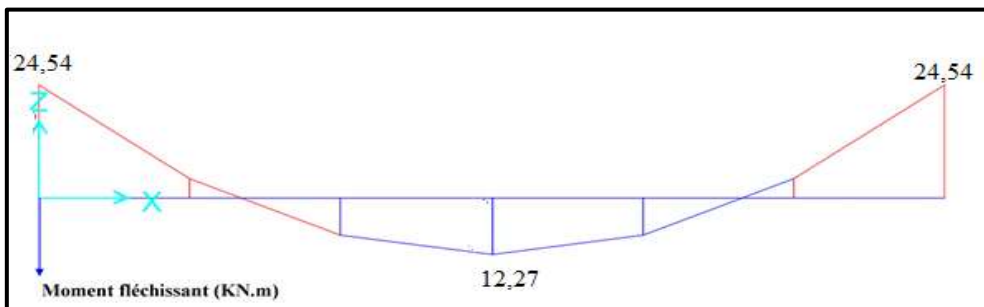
Diagramme de moment fléchissant de la poutre de la rampe à l'ELU
